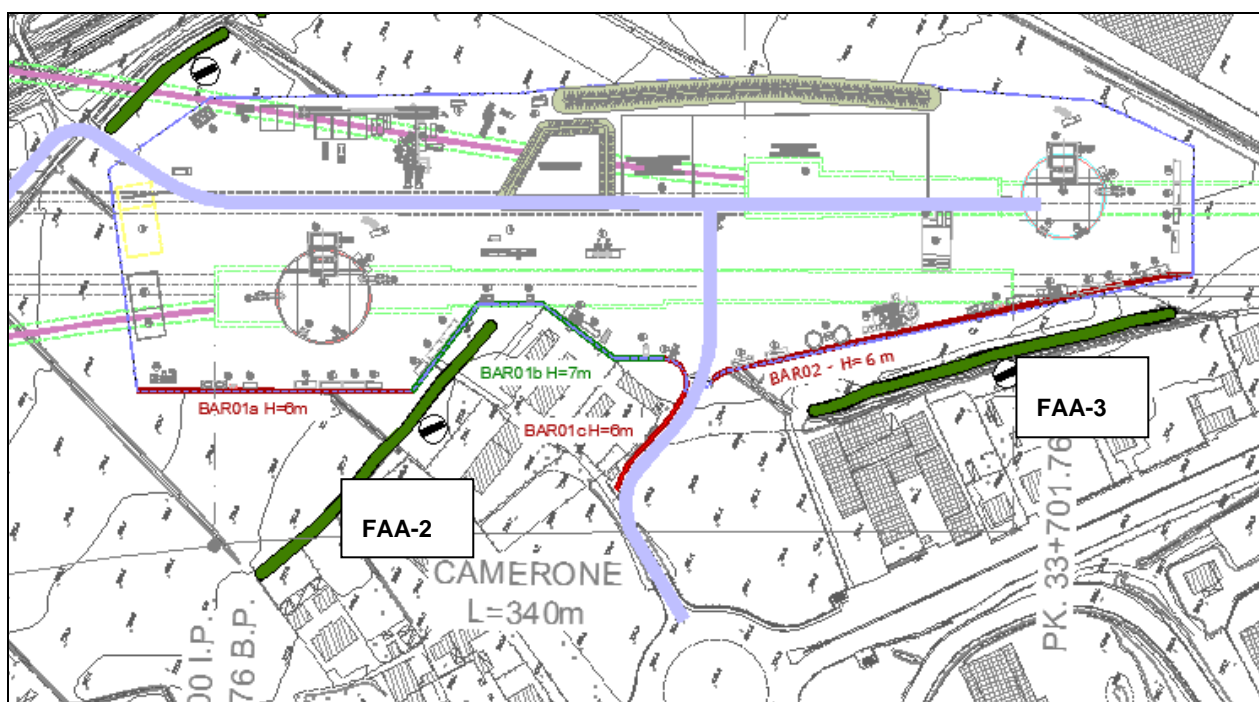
Stralcio planimetrico con la localizzazione delle fasce di vegetazione lungo il margine del cantiere COP6
